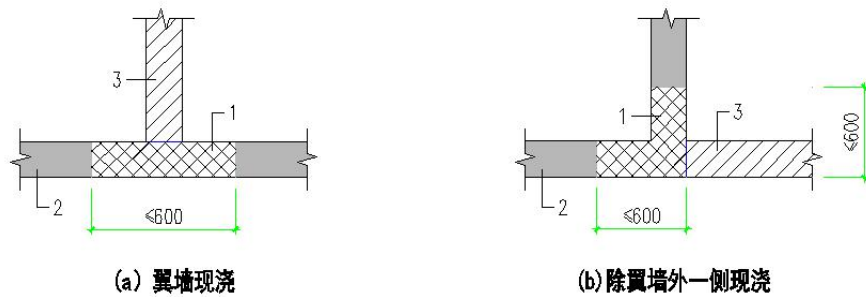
后浇混凝土 T 型连接示意（尺寸单位：mm）
